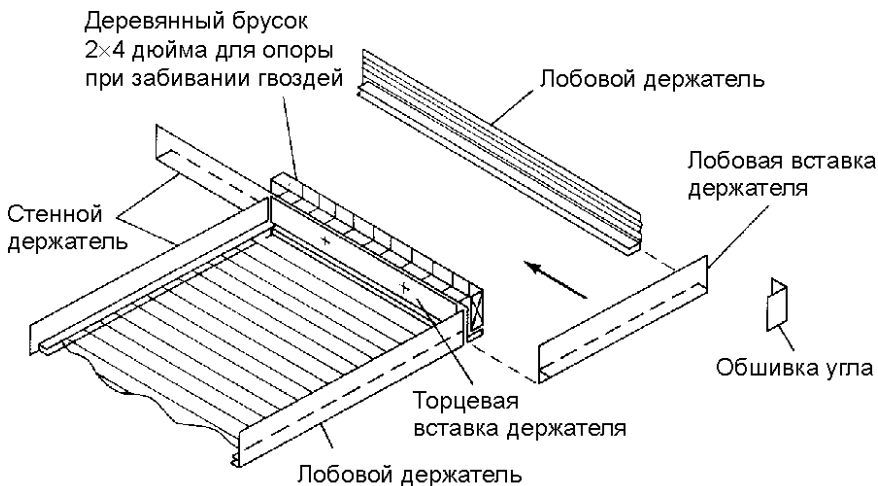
Устройство углов обшивки софита из алюминиевого материала (Reynolds Metal Products)
